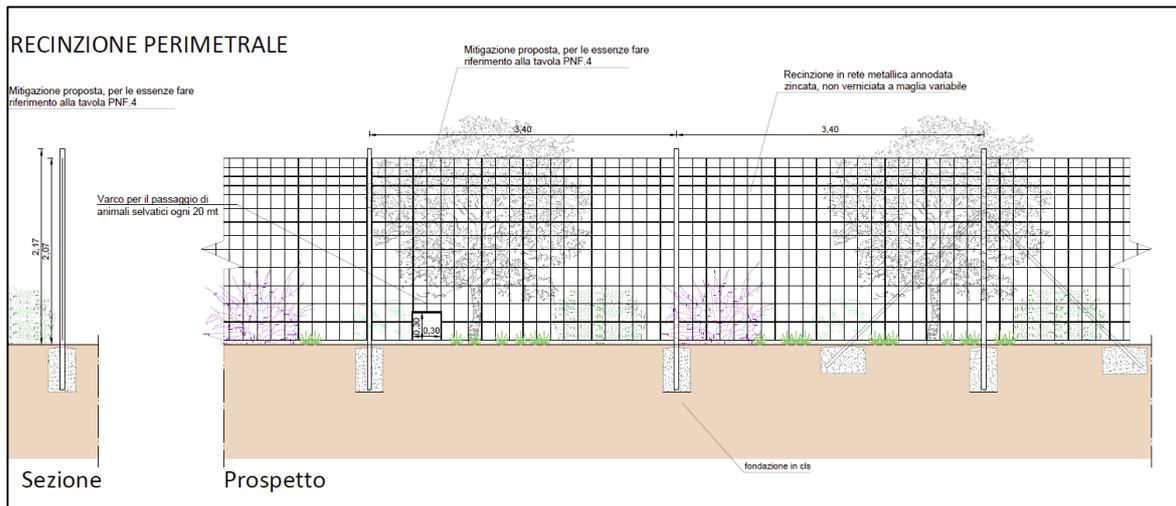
Dettaglio recinzione perimetrale con aperture di passaggio della piccola fauna
